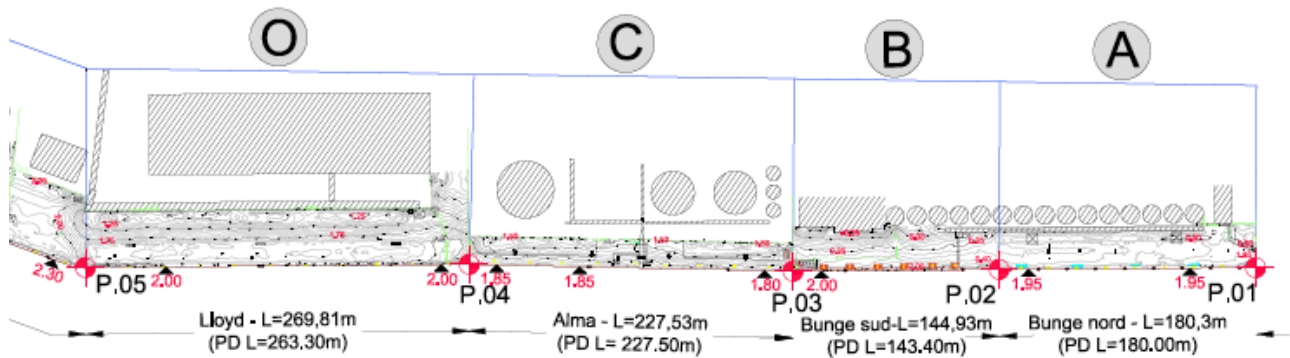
Stralcio 2 Planimetria inquadramento banchine
